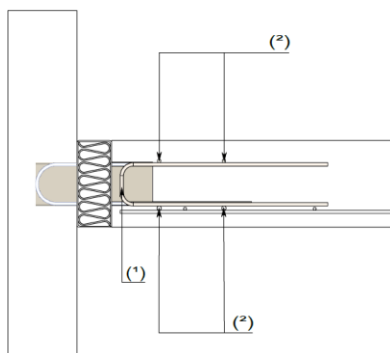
Disposition de chaînage en rive de plancher (vue en coupe)
